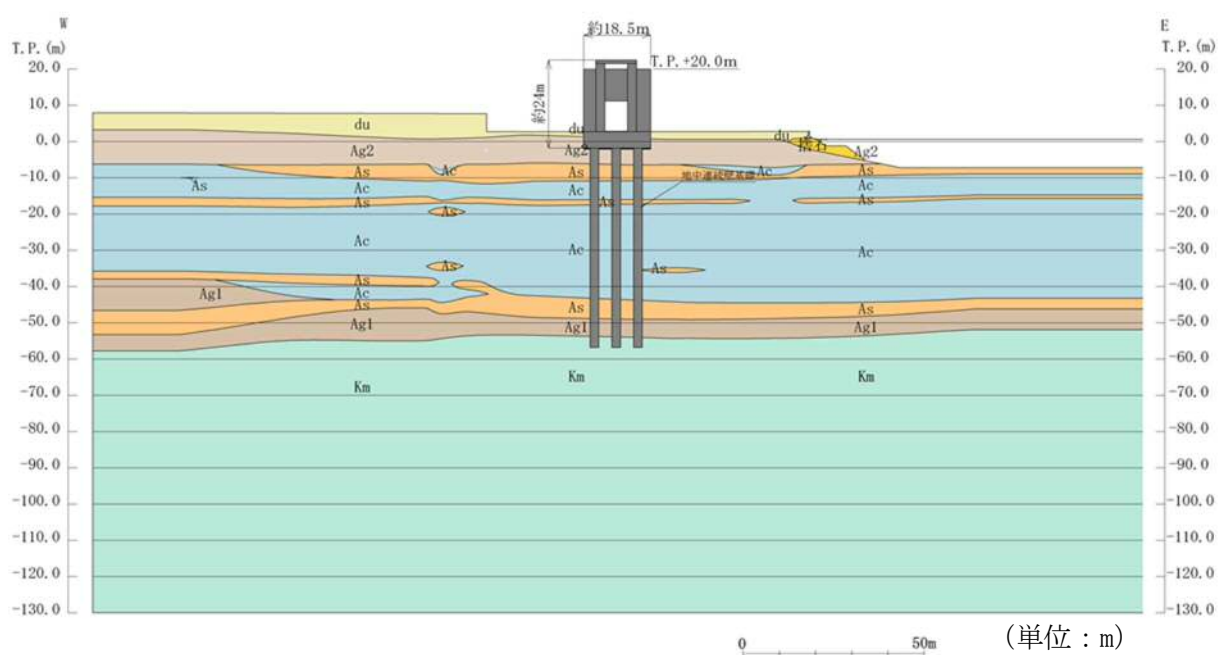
(2) 鉄筋コンクリート防潮壁 評価対象断面図 (②-②断面)
